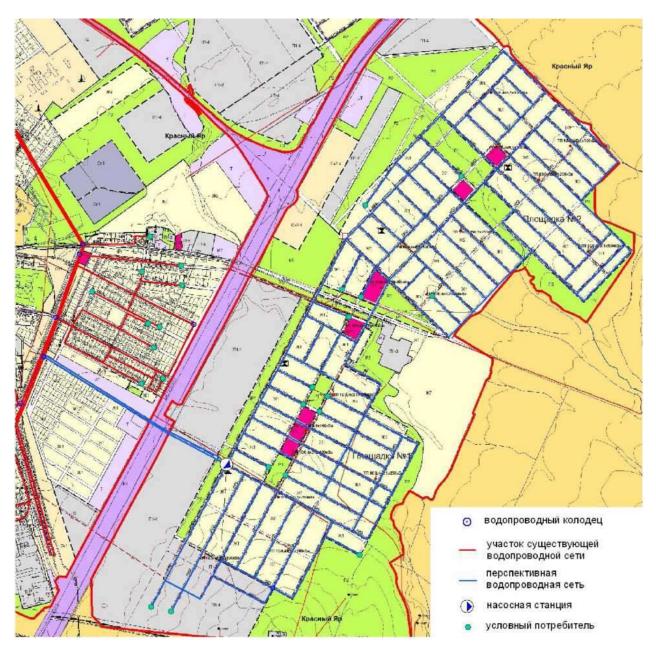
План перспективного расположения системы водоснабжения с. Красный Яр (Площадка №1, Площадка №2)
